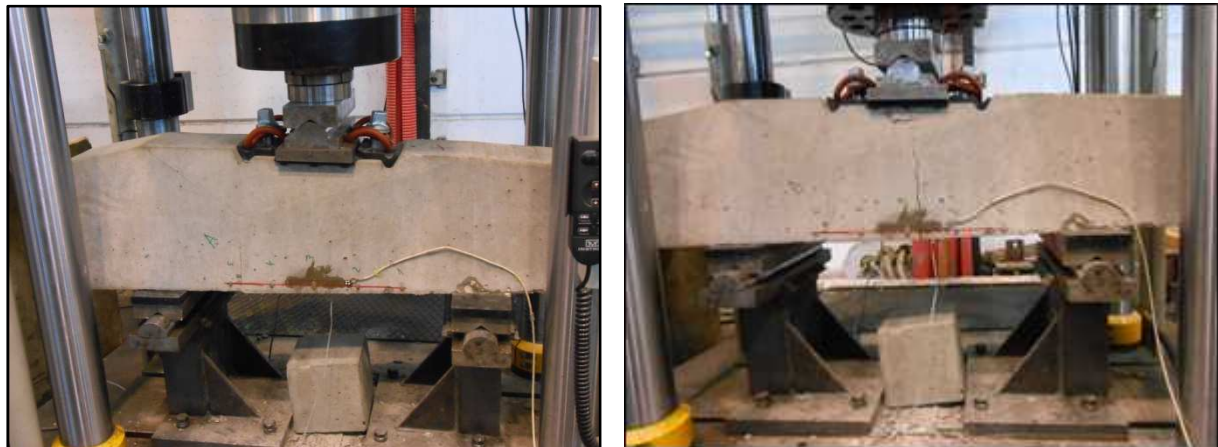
Fotografías del ensayo dinámico en sección bajo carril; a) Colocación de la galga en la superficie del hormigón, b) Aparición de fisura
